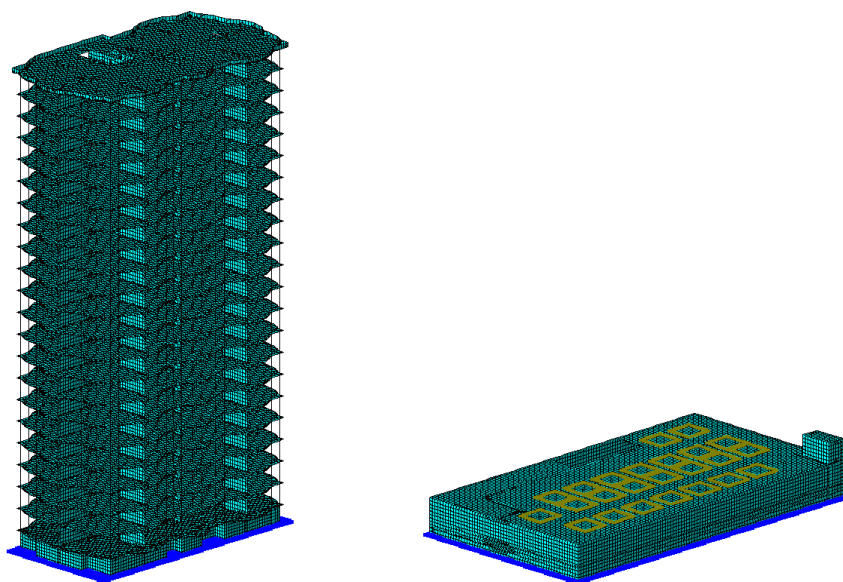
Расчетная схема жилого здания и подземной автопарковки в ПК ЛИРА-САПР
